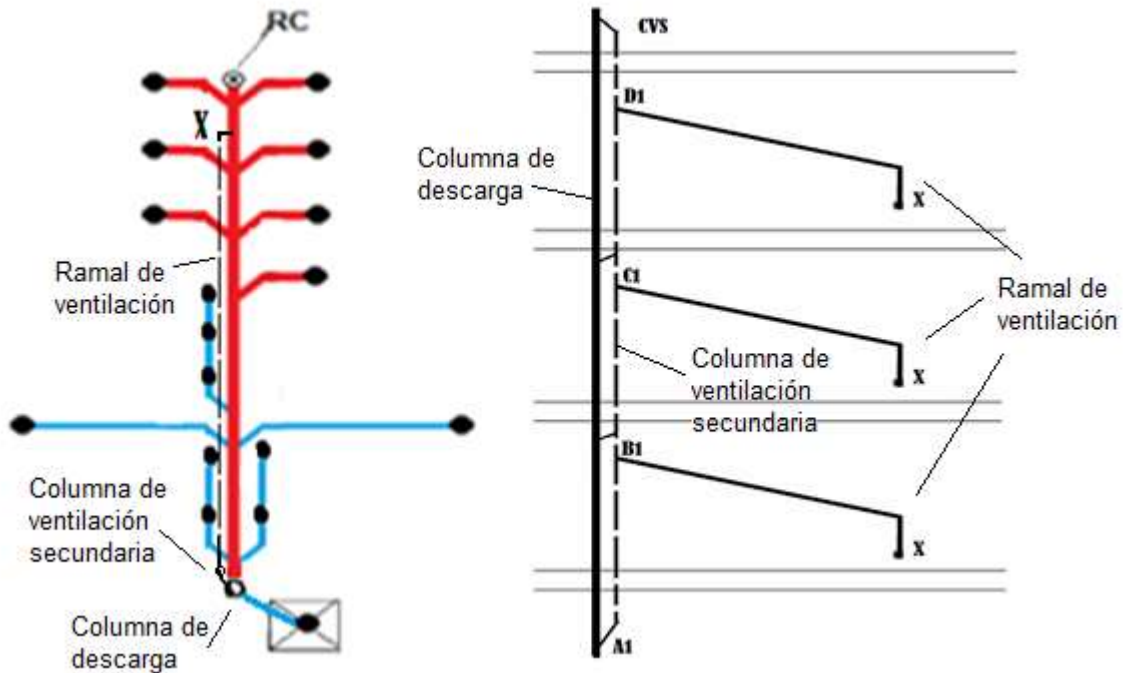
Esquema en planta y elevación de derivación y columna de ventilación
